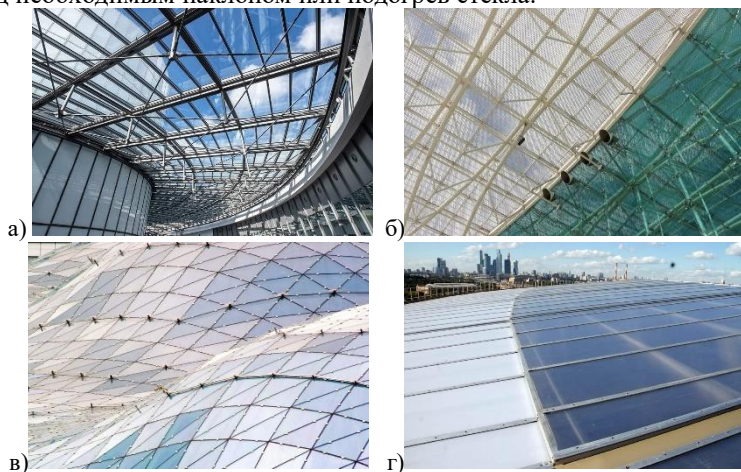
Материалы светопрозрачного покрытия: а-закаленное стекло, б-армированное стекло, в-многослойное силикатное стекло, г-полимерные панели
